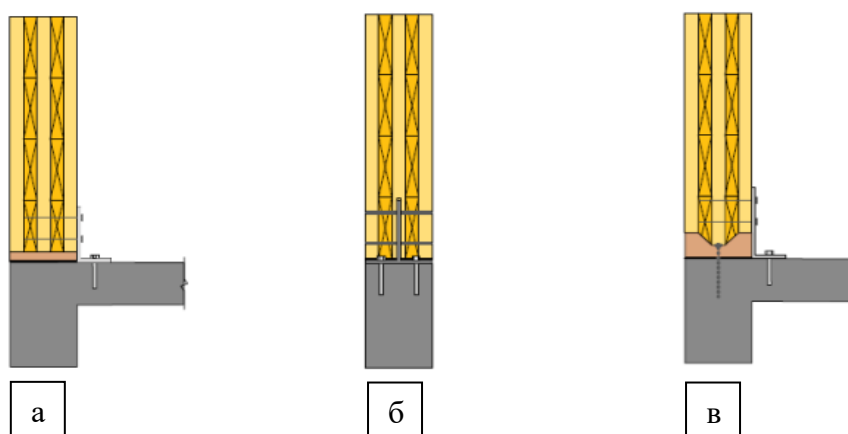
Сопряжение стен из ДПК с фундаментом: а – открытое с использованием металлического уголка; б – скрытое; в – с использованием деревянного профиля [200]
